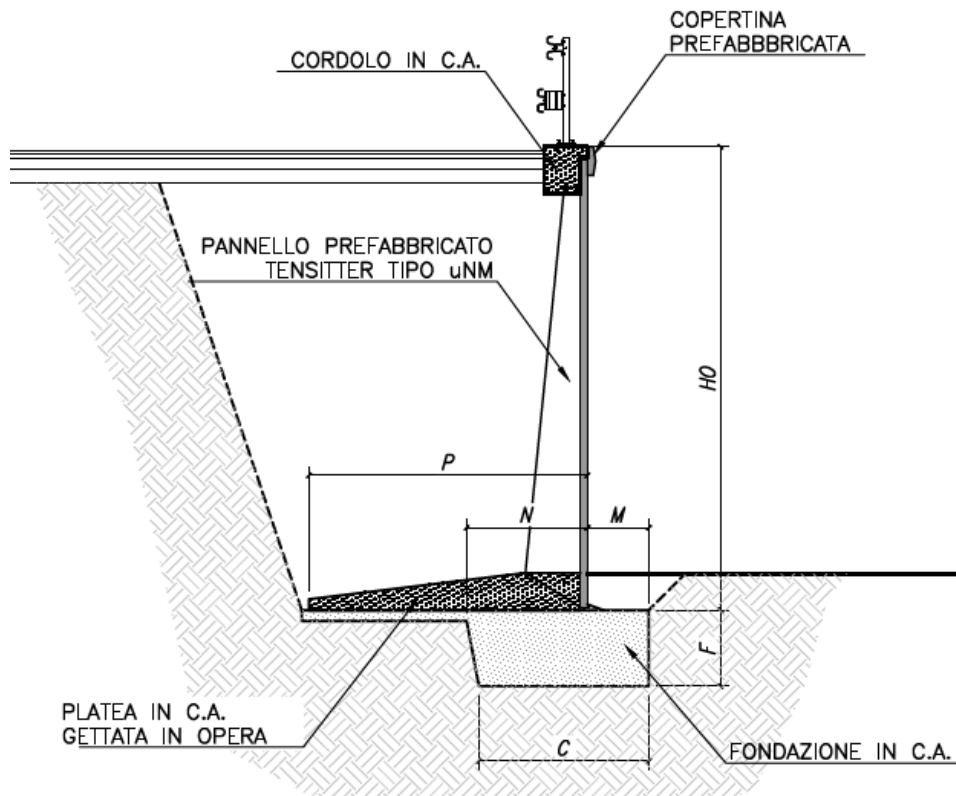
Sezione tipologica muro prefabbricato di tipo "uNM"
